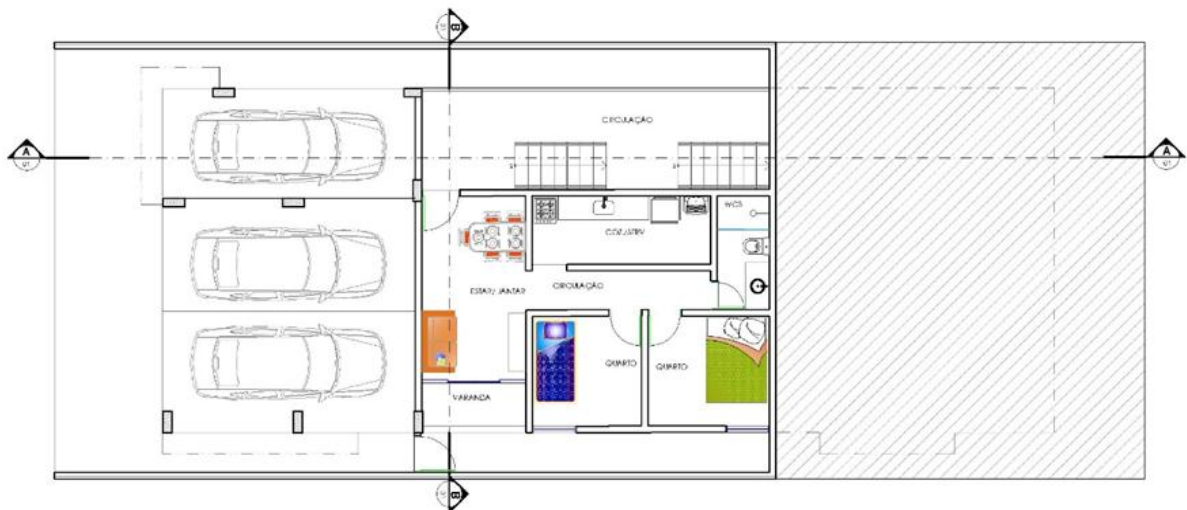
Planta baixa pavimento térreo proposta final. Fonte: acervo próprio.
